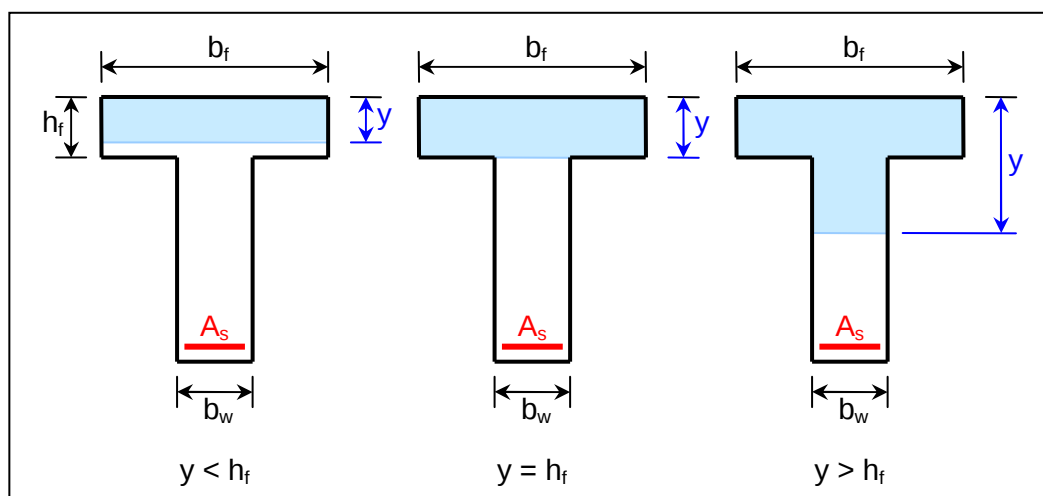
Regiões de concreto comprimido em vigas de seção T
